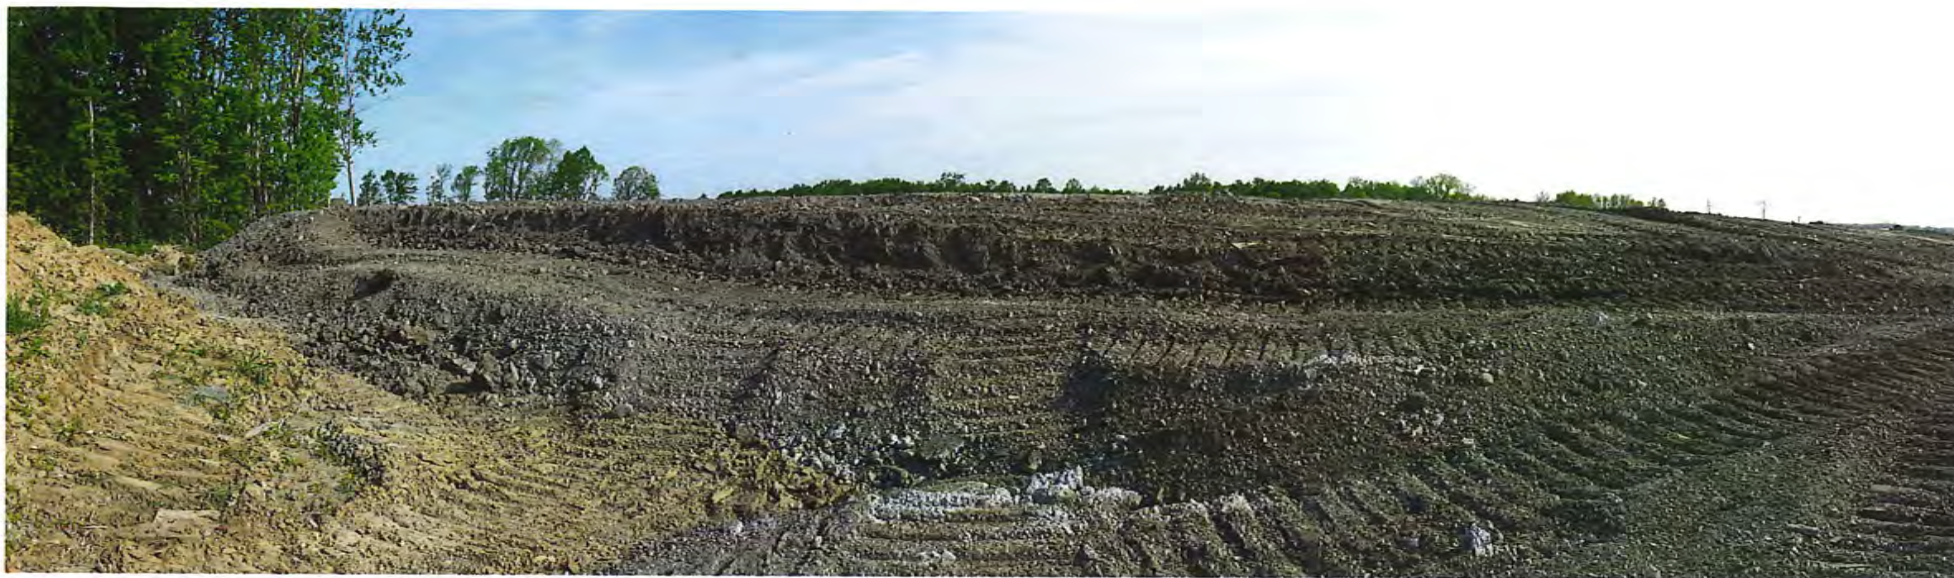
Remblai vu de la hauteur du remblai vers le lot 3 847 595
